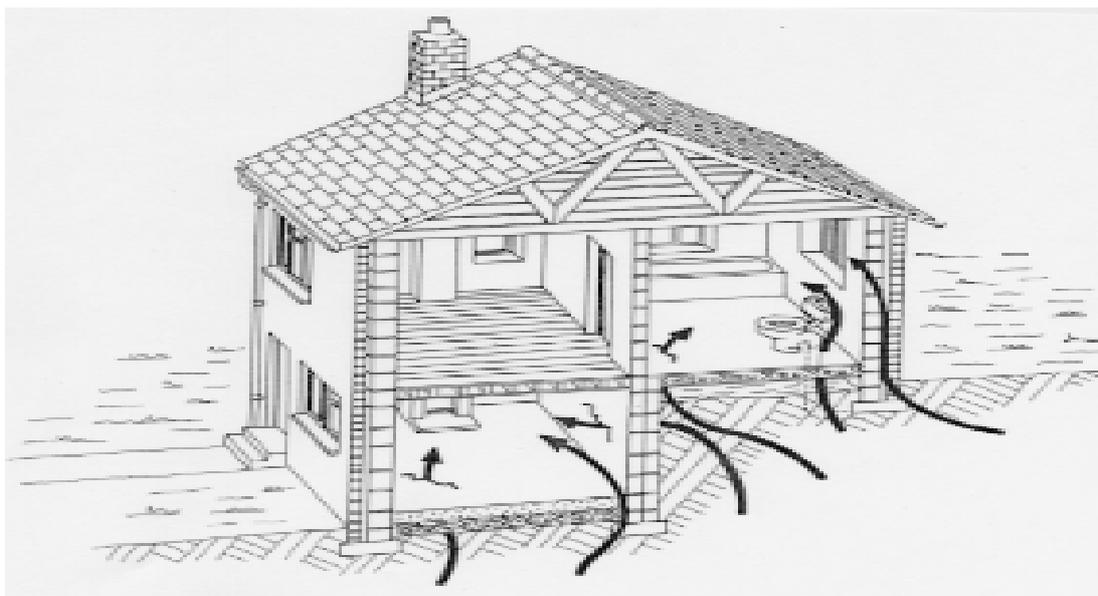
Il radon entra dalle numerose aperture, crepe e fessure presenti nel solaio gettato sul terreno o rialzato, dalle entrate delle canalizzazioni di servizio o attraverso le fondazioni
